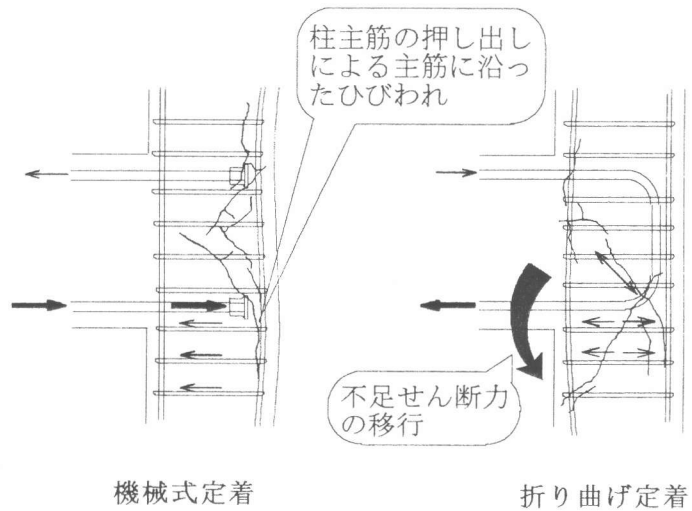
典型的なひび割れ状況と応力伝達機構
